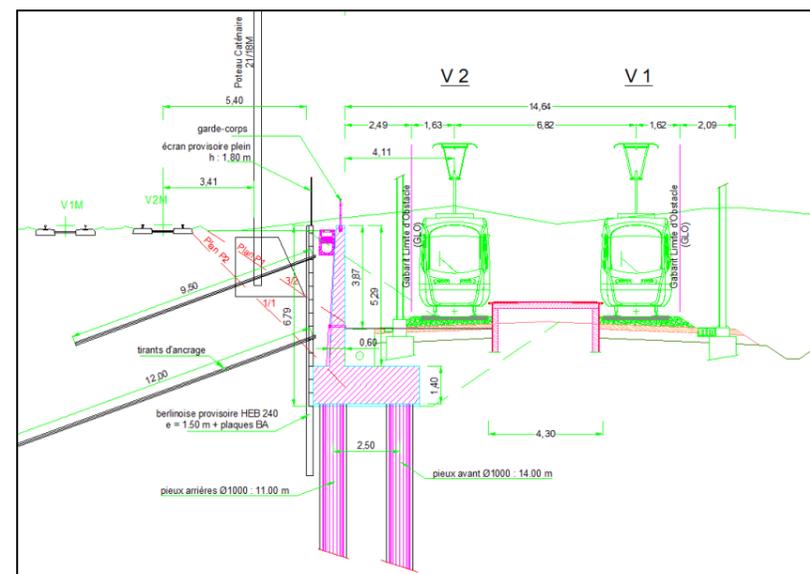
Coupe de principe du mur de soutènement de la virgule de Saint-Cyr-l'Ecole en station (Source : AVP- juillet 2015)
